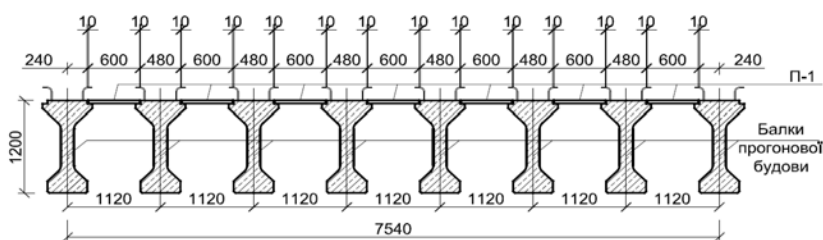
Приклад розкладки плит незнімної опалубки
